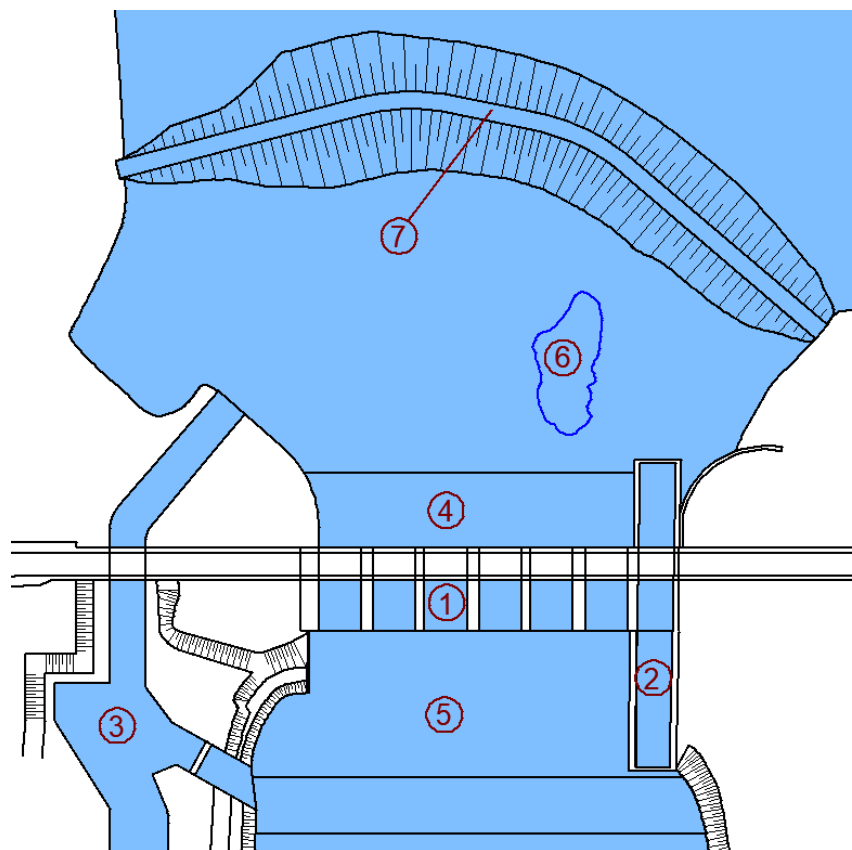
Схема расположения временной грунтовой плотины на плане основных сооружений гидроузла
